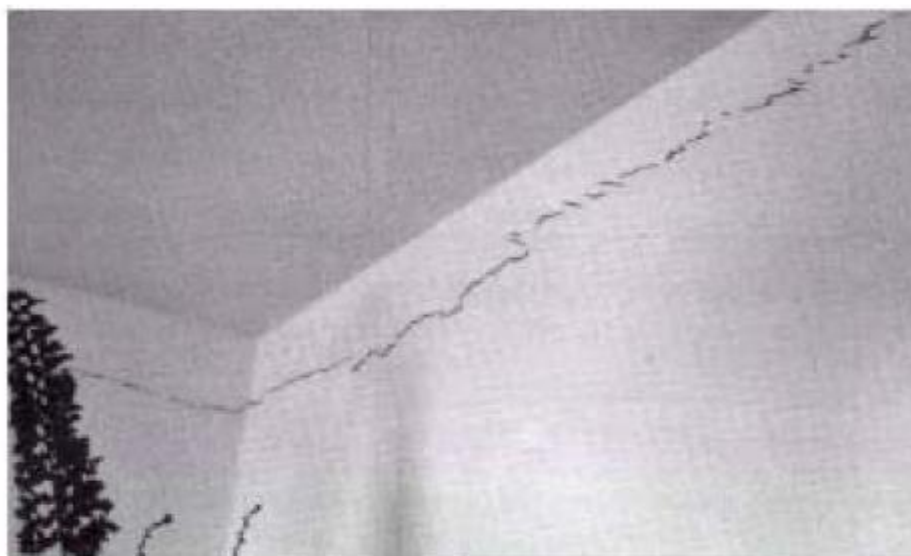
Fissuras Horizontal com componentes Inclinados escamas por movimentação da laje de cobertura Fonte Duarte (1998)
